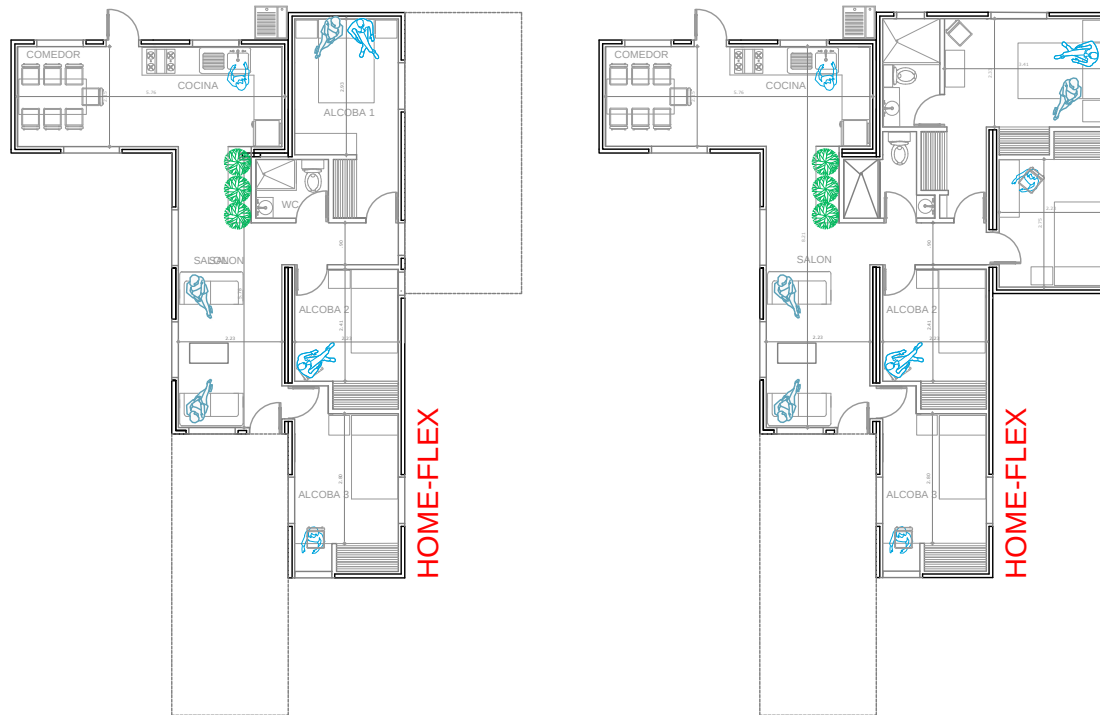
HOME-FLEX*, planta arquitectónica en tipología aislada. Elaboración propia.
